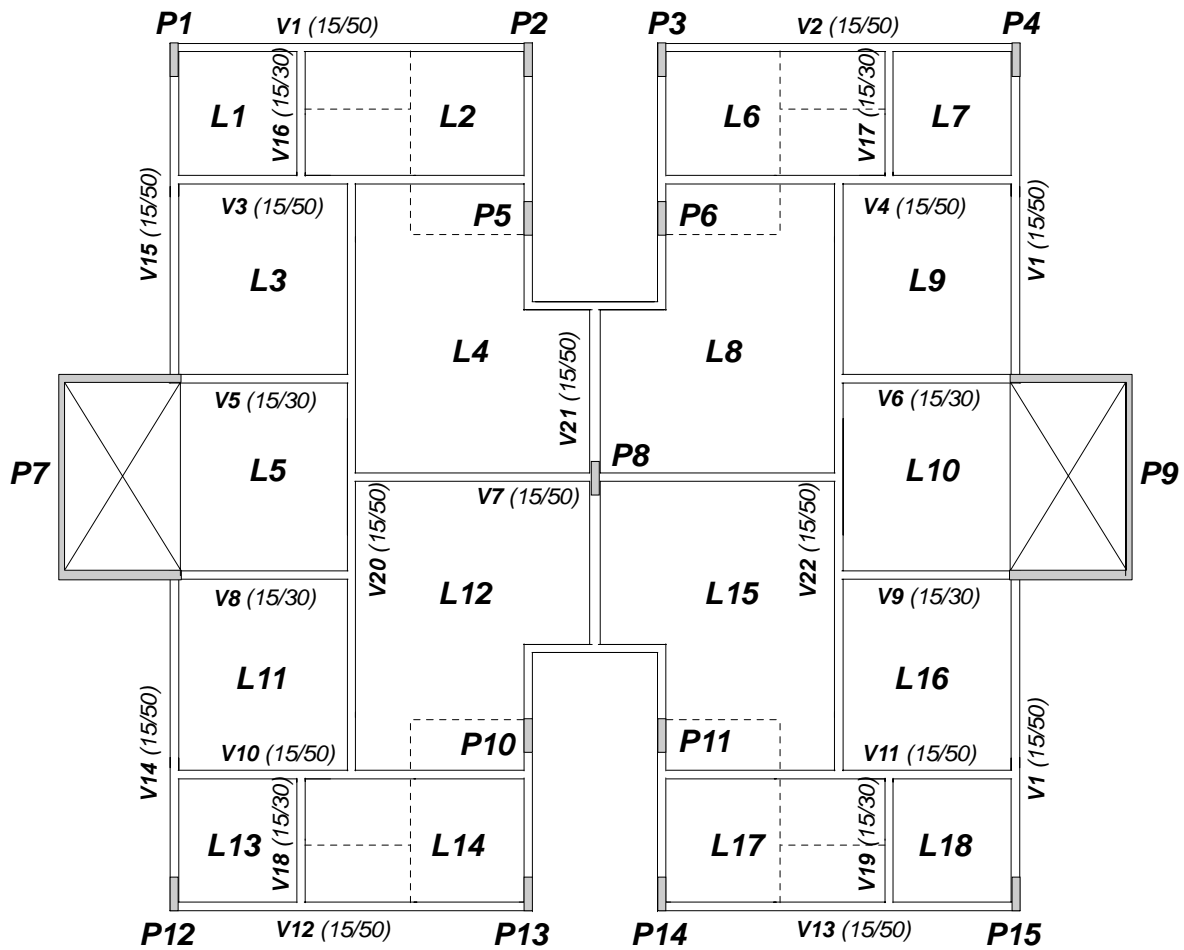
Planta de Fôrmas do Pavimento-Tipo
